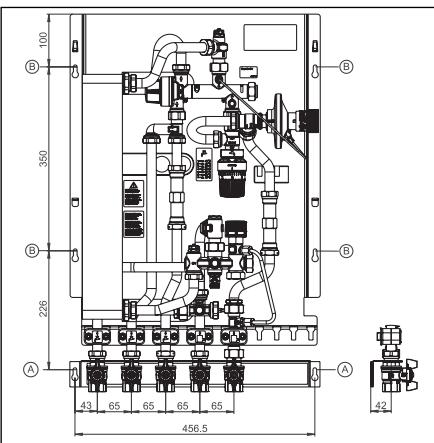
Anschlussschema Kugelhahnanschlussleiste 1341083
